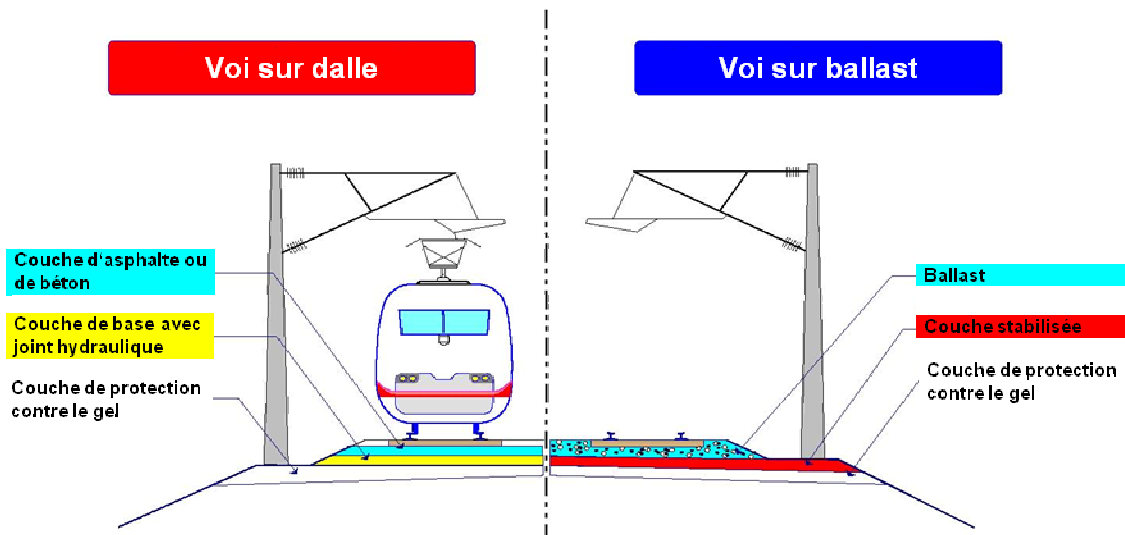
Voie sur Ballast et sur Dalle (Mißler, [8])
